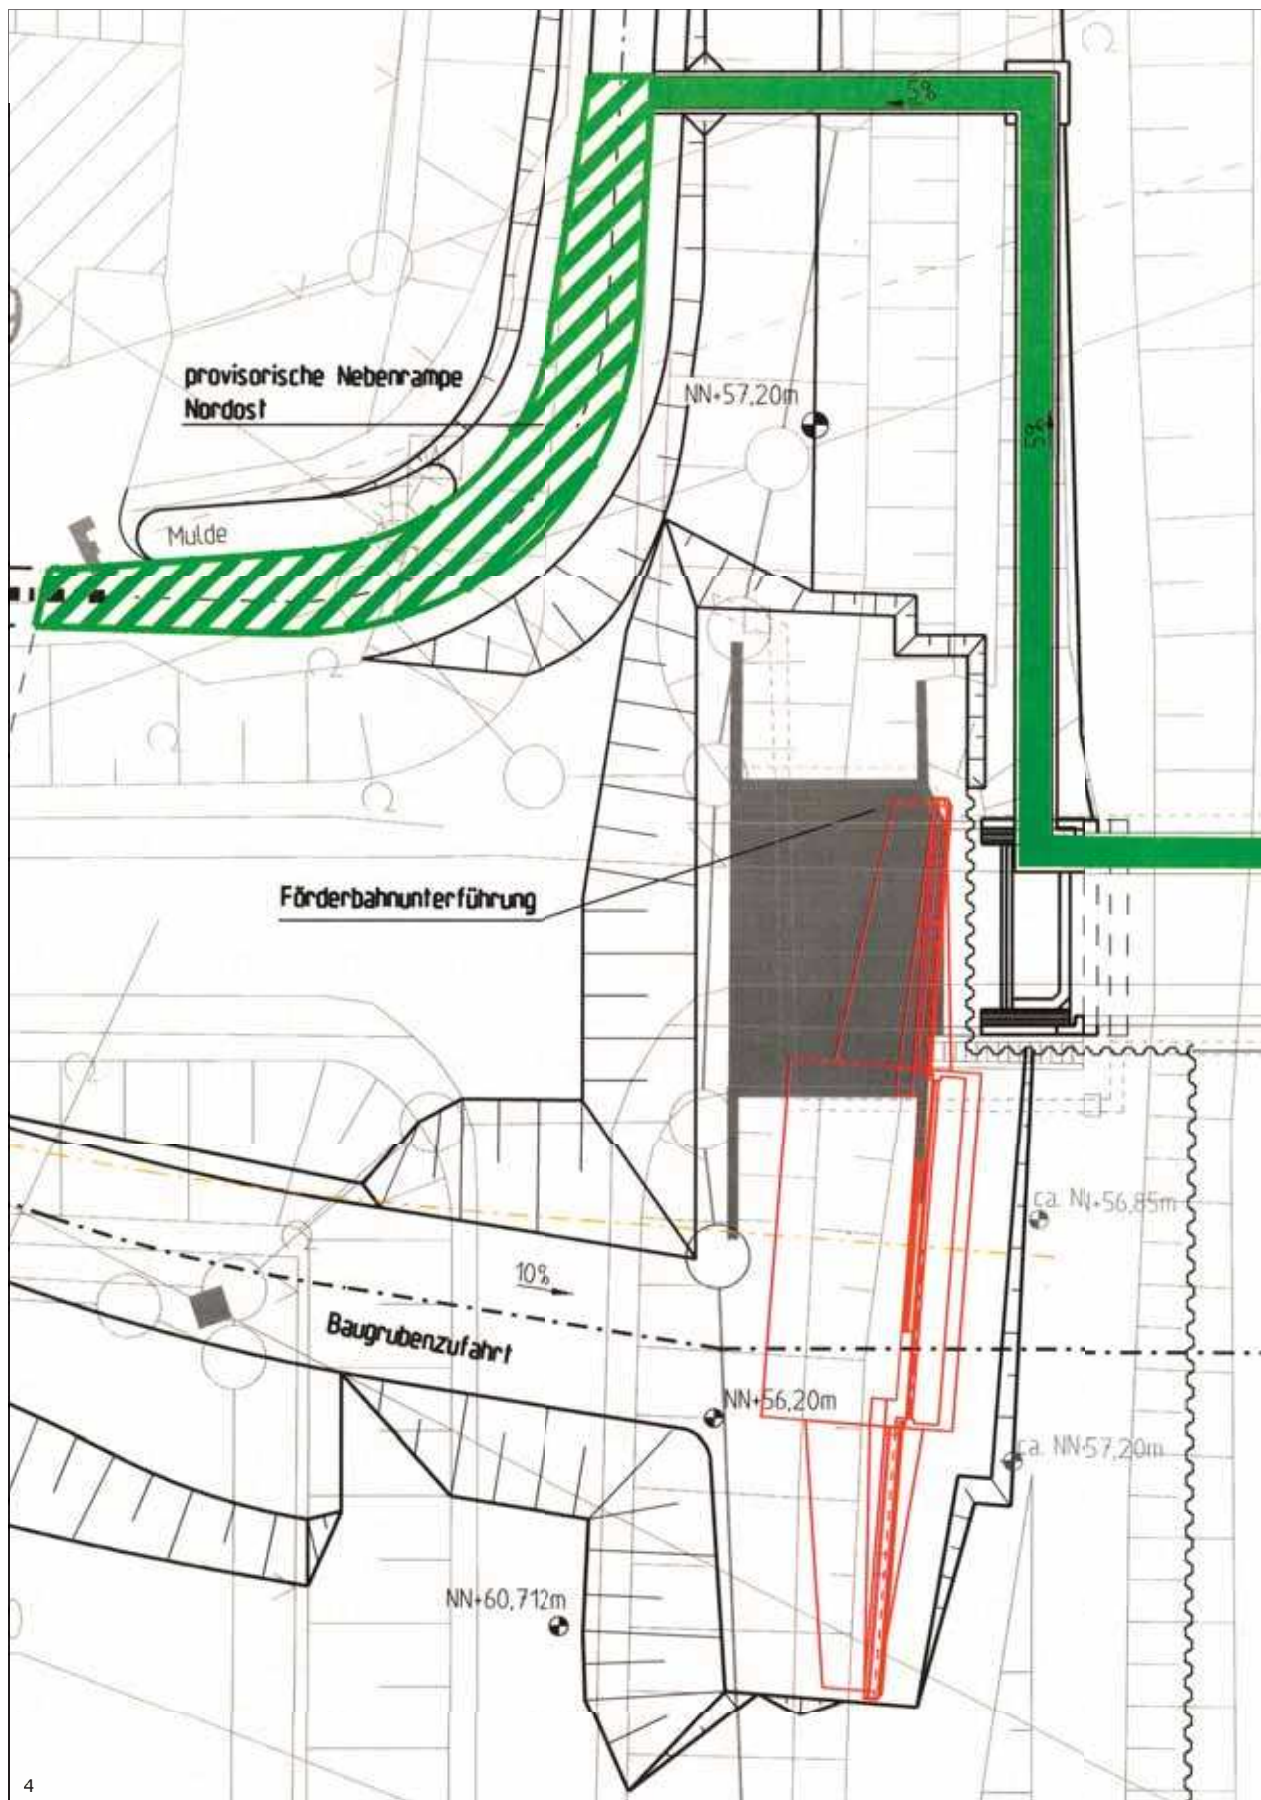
Lageplan Nordseite mit Verkehrsführung
